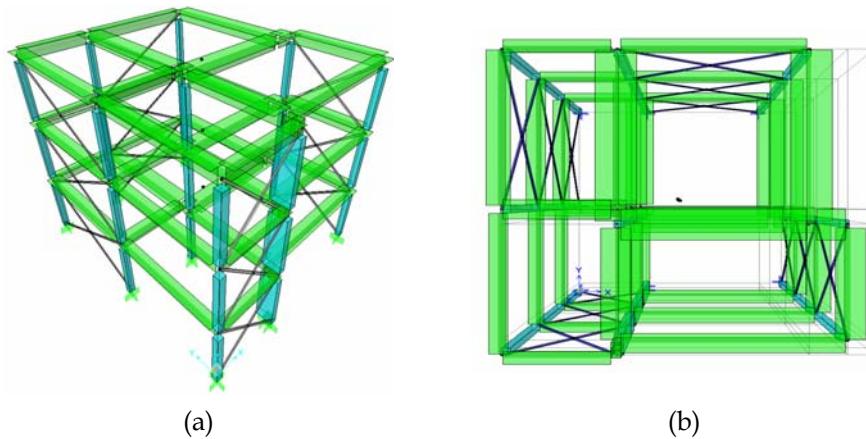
Configurazione dei controventi in due viste prospettiche: laterale (a) ed in pianta (b)
